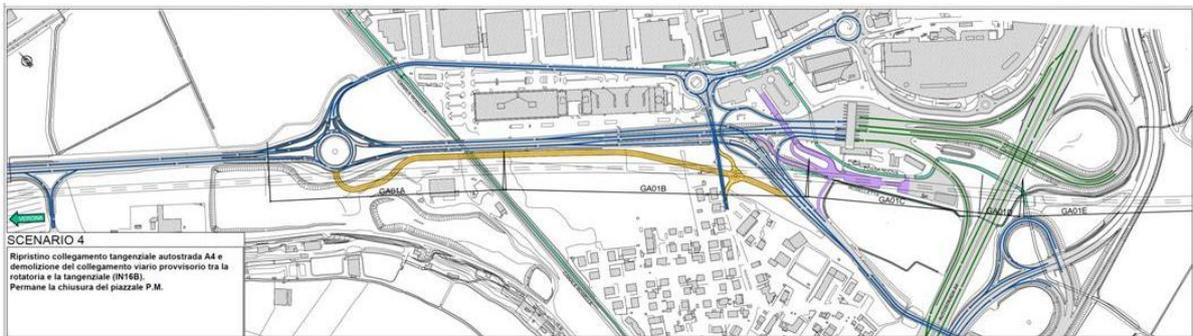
Assetto di rete dello Scenario di cantierizzazione #4
